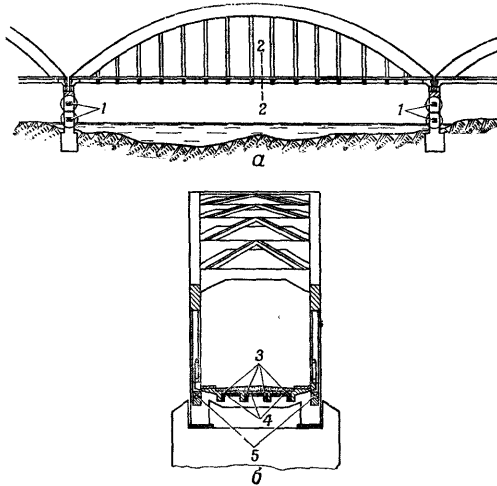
Подрывание железобетонного моста с пролетным строением на безраспорных арках с затяжками:
